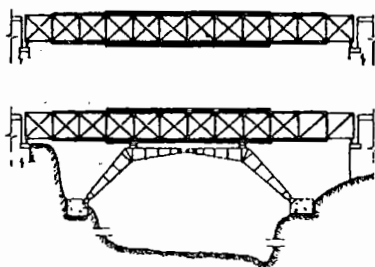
Reforço em viga treliçada simplesmente apoiada com pórticos criando dois apoios intermediários
